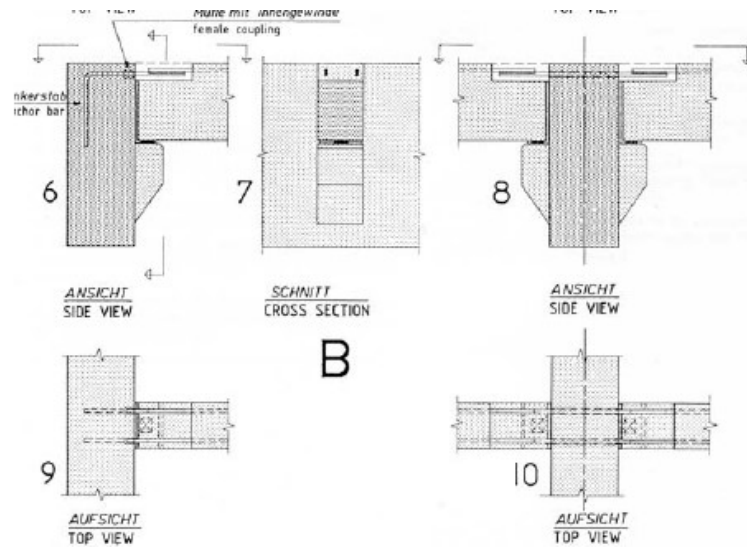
Ligação por consolo e barras de aço soldadas (Stupré, 1981)
